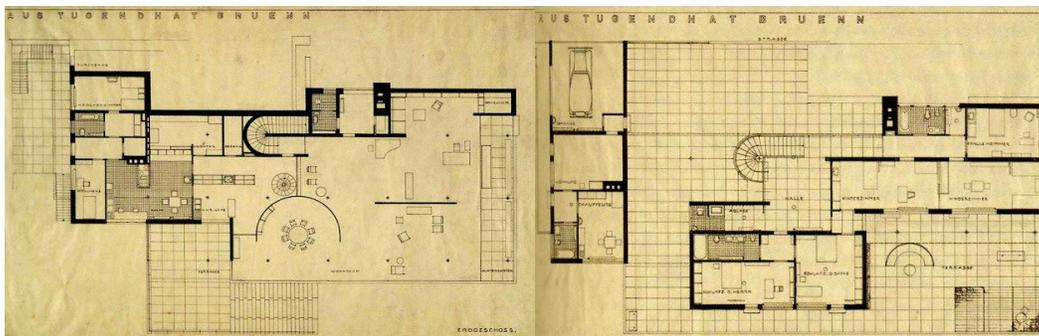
CASA TUGENDHAT, PLANTAS ARQUITECTÓNICAS (IZQUIERDA PLANTA BAJA, DERECHA PLANTA ALTA). (CASTELLANOS, 2016)
